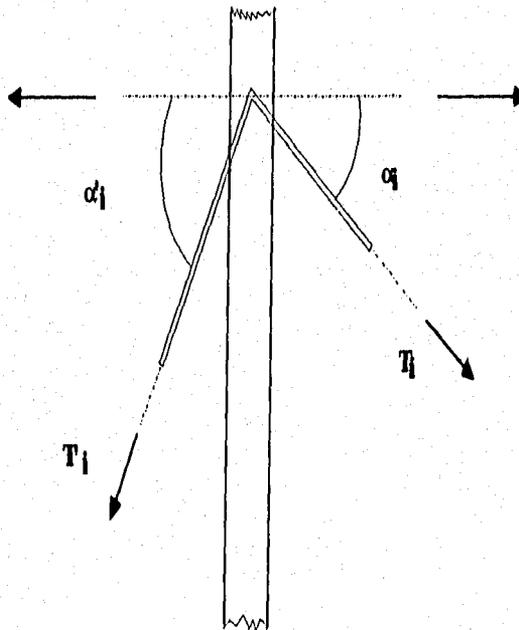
Balance perfecto de las fuerzas horizontales en el pilón, para cargas permanentes.
